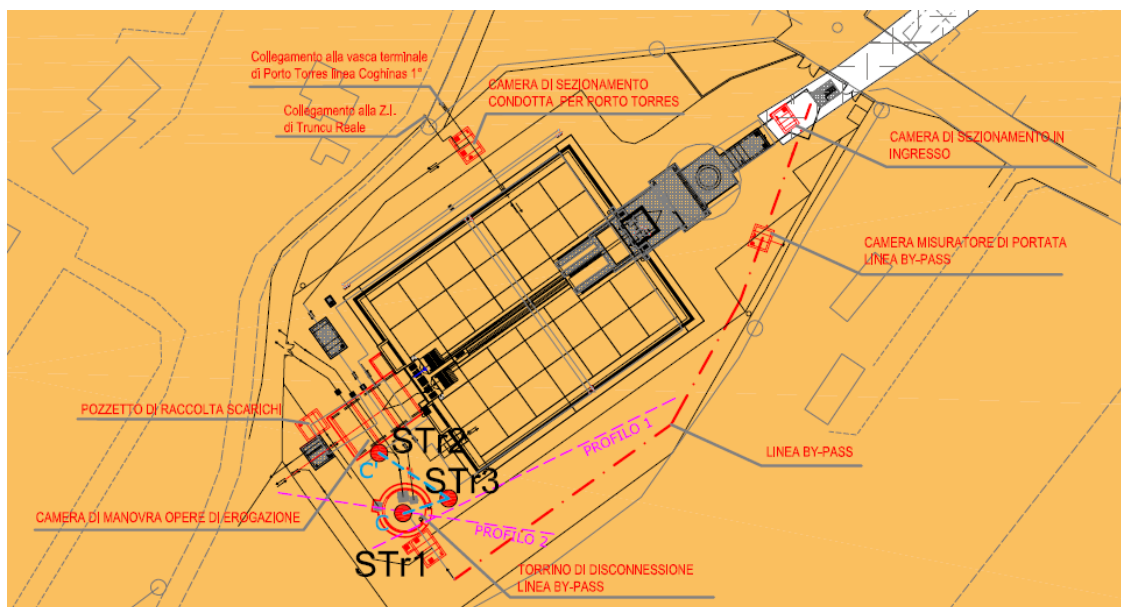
Area di progetto di Truncu Reale – Planimetria con individuazione sondaggi geognostici realizzati
